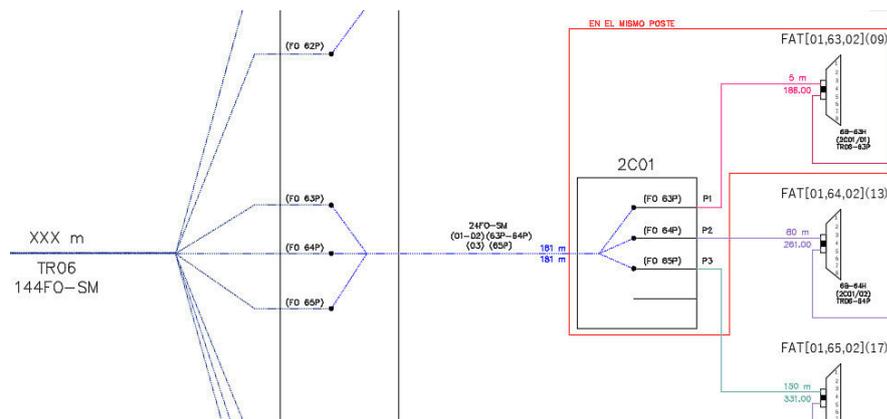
Vista ampliada del plano AS-BUILT i5. Fuente: Elaboración propia
